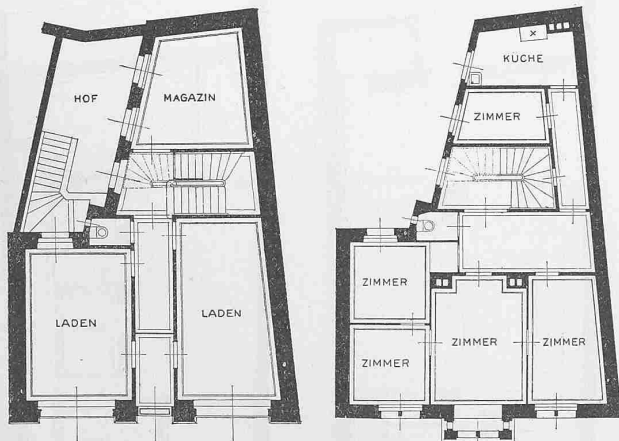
Das Haus «Zum Platanenbaum», Freie Strasse Nr. 72. Grundrisse vom Erdgeschoss und vom II. Stock. — Masstab 1 : 250.
